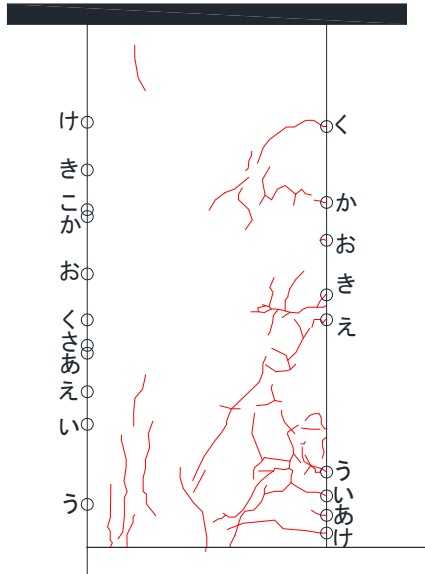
柱ひび割れ幅測定位置(試験体 C-3 負載荷)
